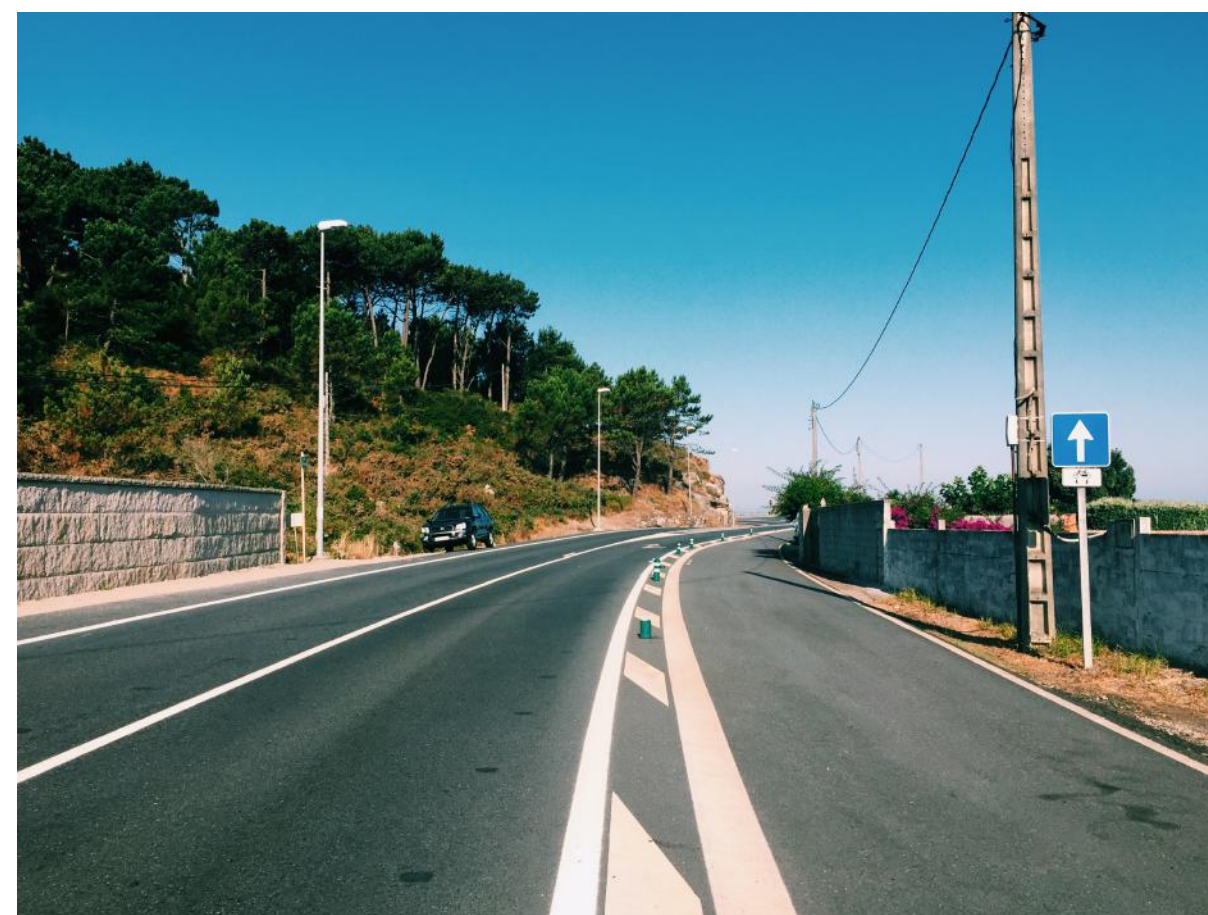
SECCIÓN TIPO ARCÉN-BICI EN LOS PRIMEROS 3 KM.
